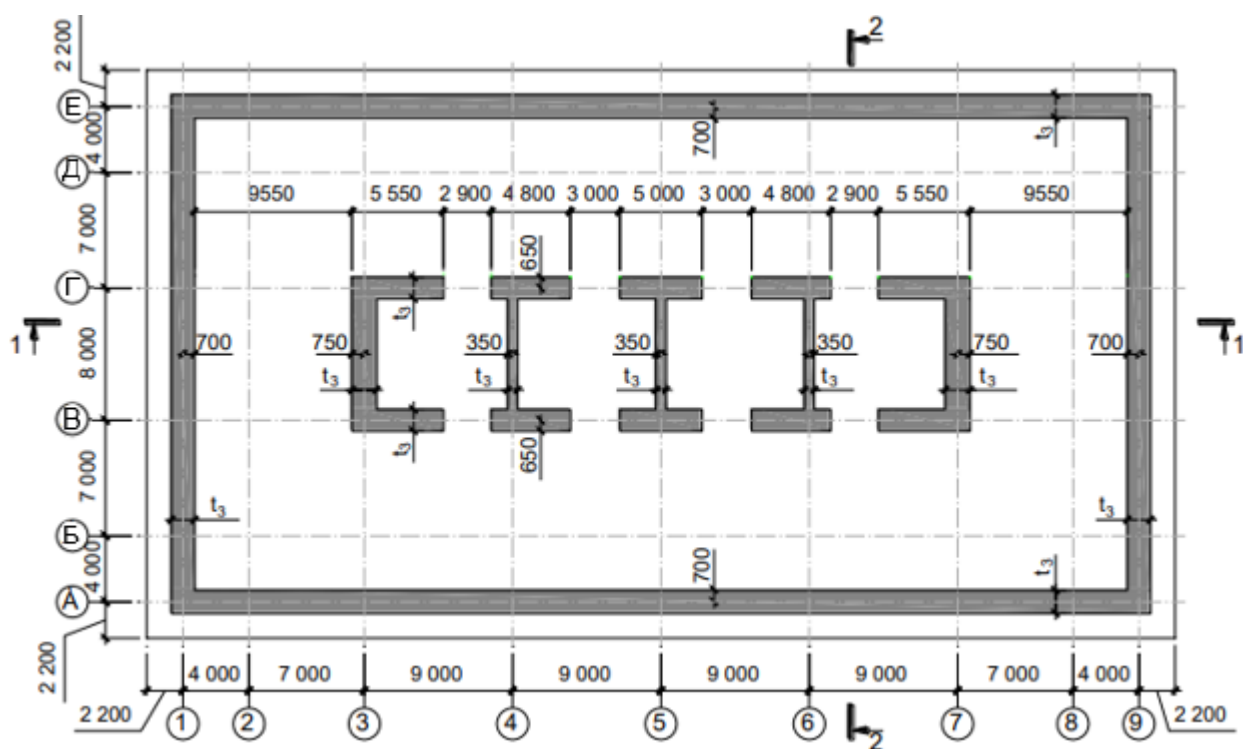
Схематический план подземного -3 этажа.
